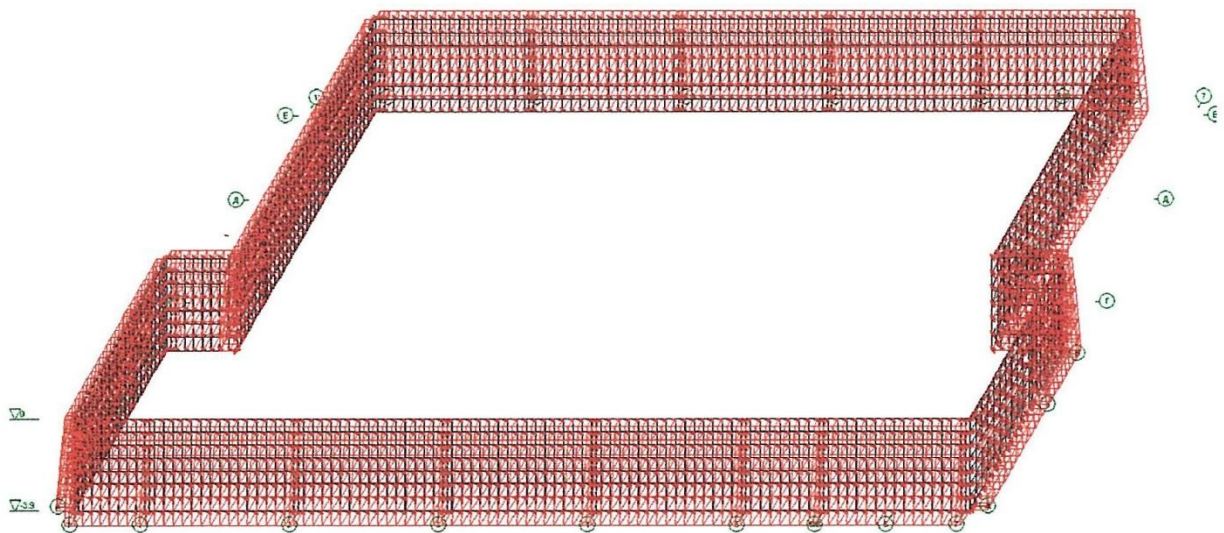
Схема завантаження 2 – Постійне навантаження від ґрунту, т/м
